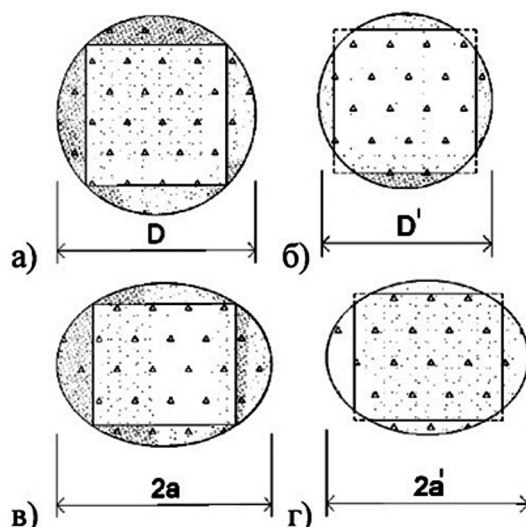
Усиление квадратных (а, б) и прямоугольных (в, г) колонн с изменением их формы поперечного сечения соответственно на круглую и эллипсовидную
